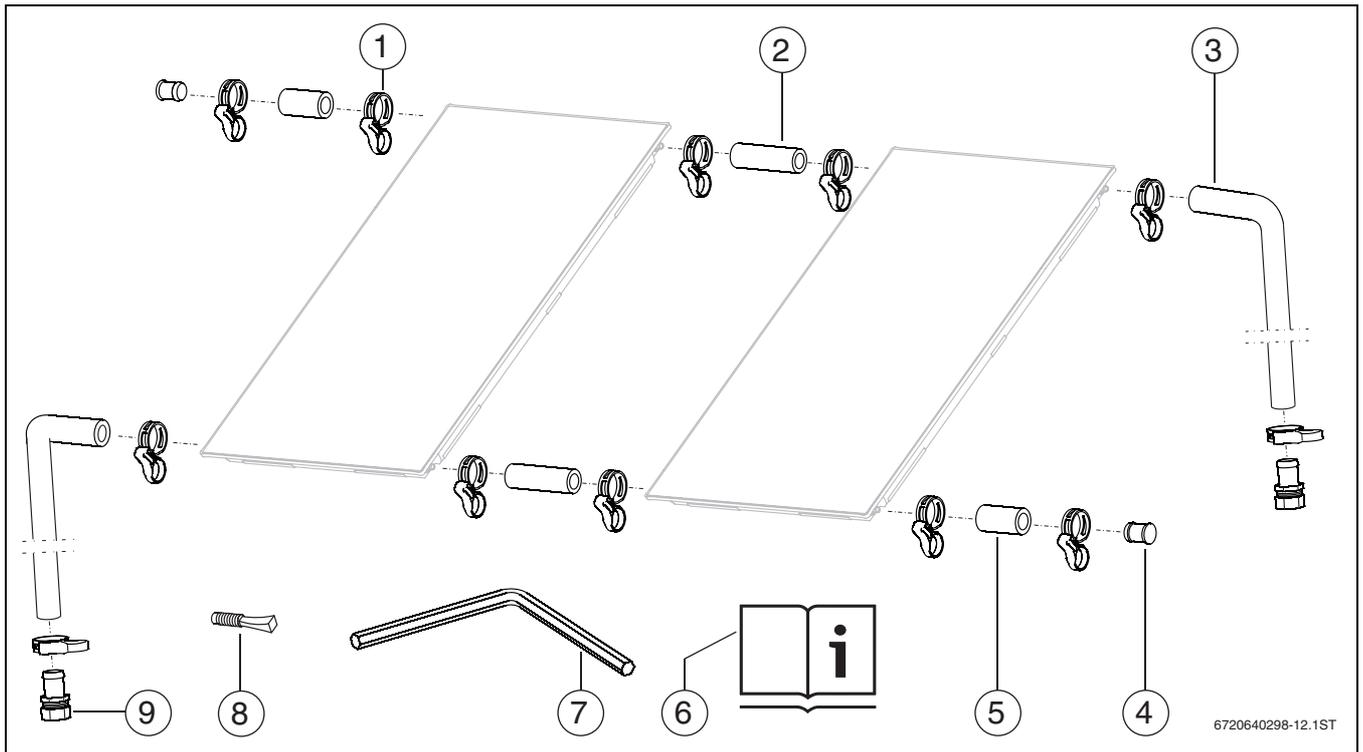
1 conjunto de ligação sobre o telhado e 2 módulos de ligação
